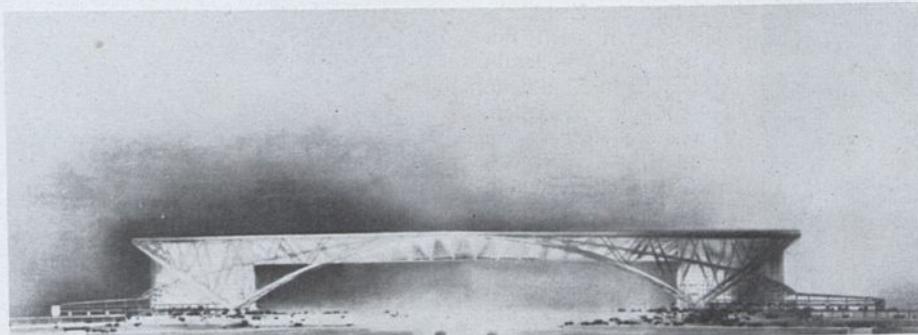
Entwurf Baudouin und Lods für die Pariser Ausstellungshalle.
